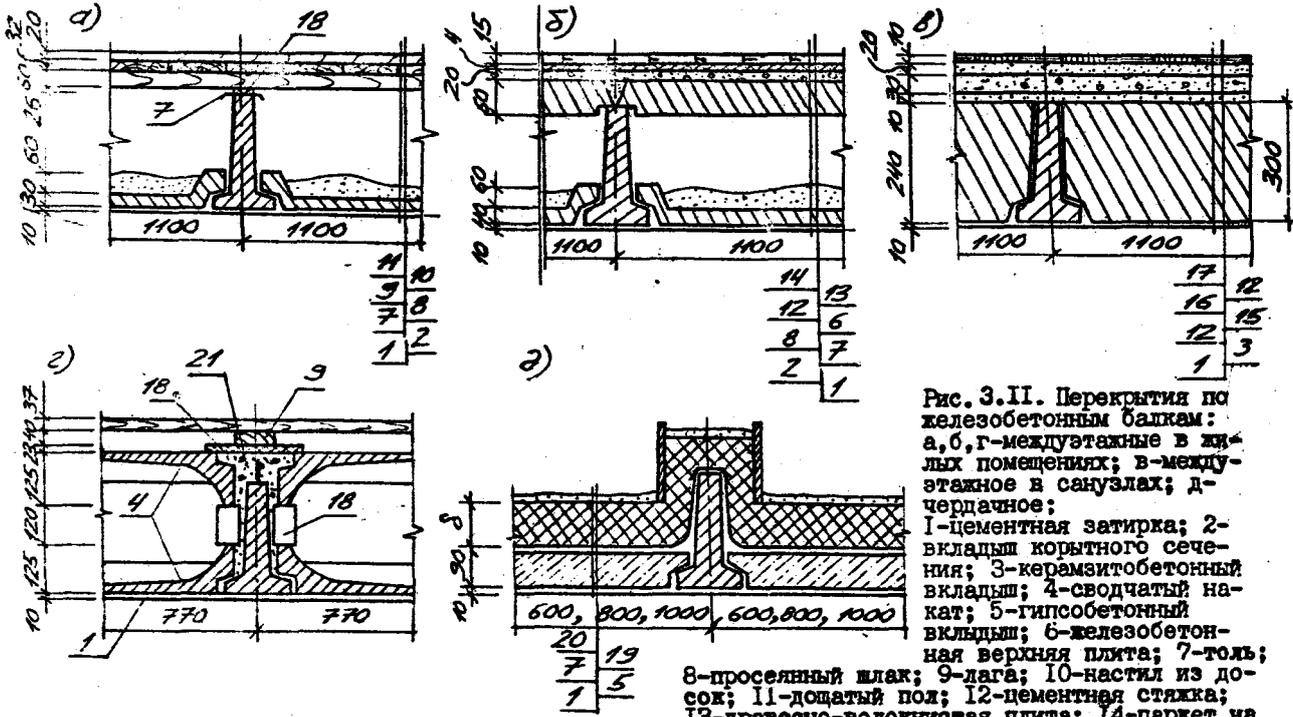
Перекрытия по железобетонным балкам: а, б, г-междуэтажные в жилых помещениях; в-междуэтажное в санузлах; д-чердачное; 1-цементная затирка; 2-вкладыш корытного сечения; 3-керамзитобетонный вкладыш; 4-сводчатый накат; 5-гипсобетонный вкладыш; 6-железобетонная верхняя плита; 7-толь;
